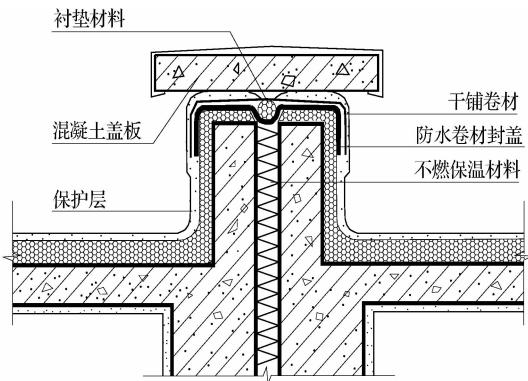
喷涂硬泡聚氨酯屋面变形缝防水构造
